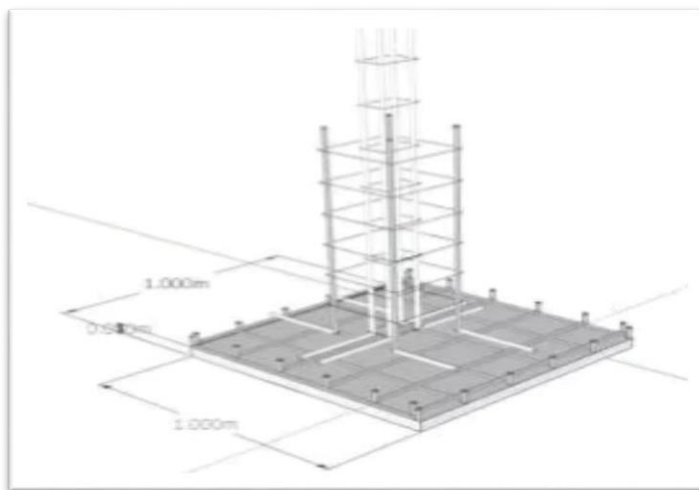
ANGELO KENNEDY. (2018). ZAPATA AISLADA. 2020, de BIBLIOCAD Sitio web:
